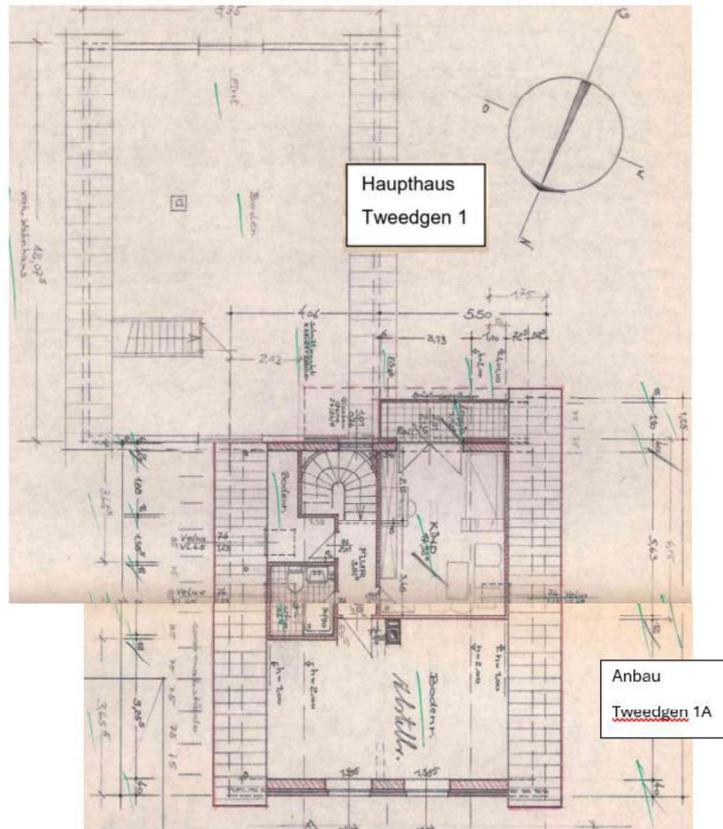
Grundriss Haupthaus und Anbau Dachgeschoss
